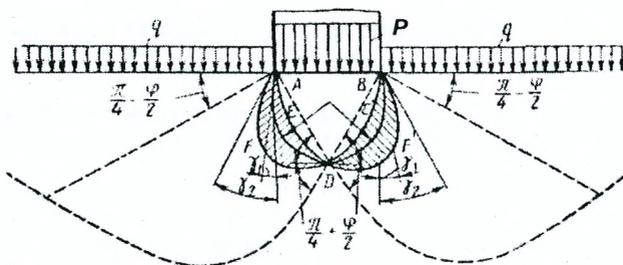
Схема к определению осадки фундамента глубокого заложения на твердом глинистом основании с учетом возникновения предельного состояния
